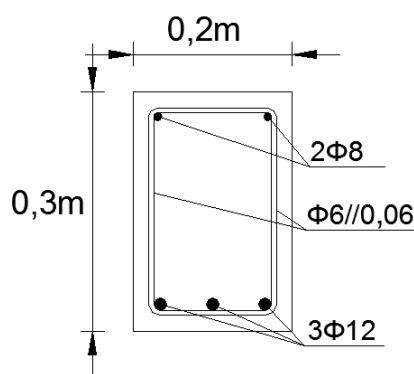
Secção transversal das Vigas 1, 2 e 3.
